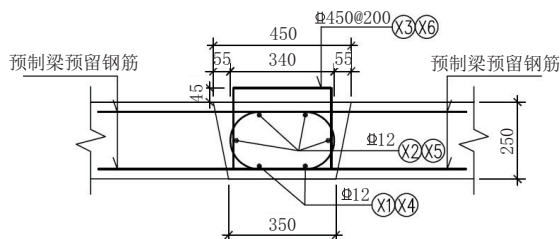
横向35 cm缝宽+环形钢筋交错布置(不焊接)构造(单位:mm)
